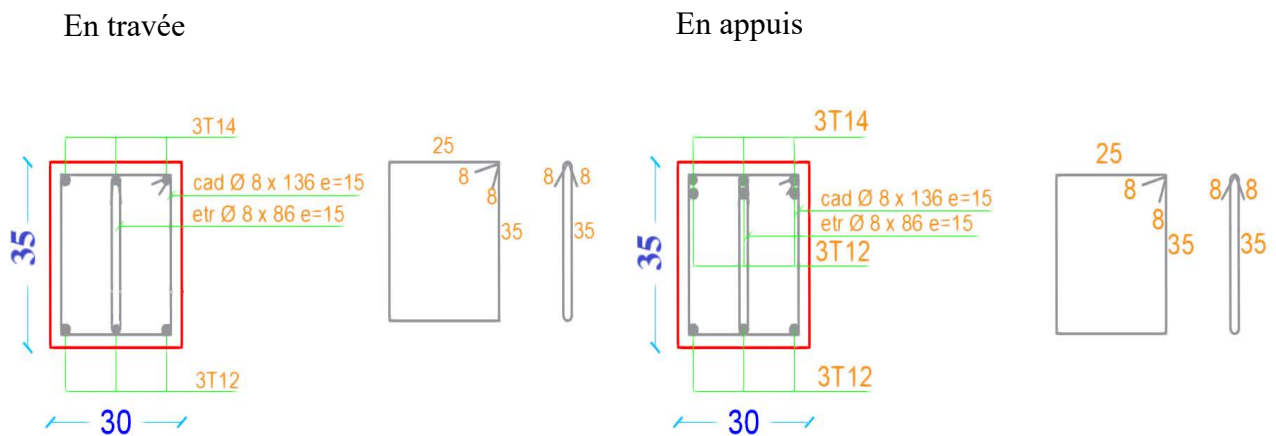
Schéma de ferrailage de la poutre Secondaire
